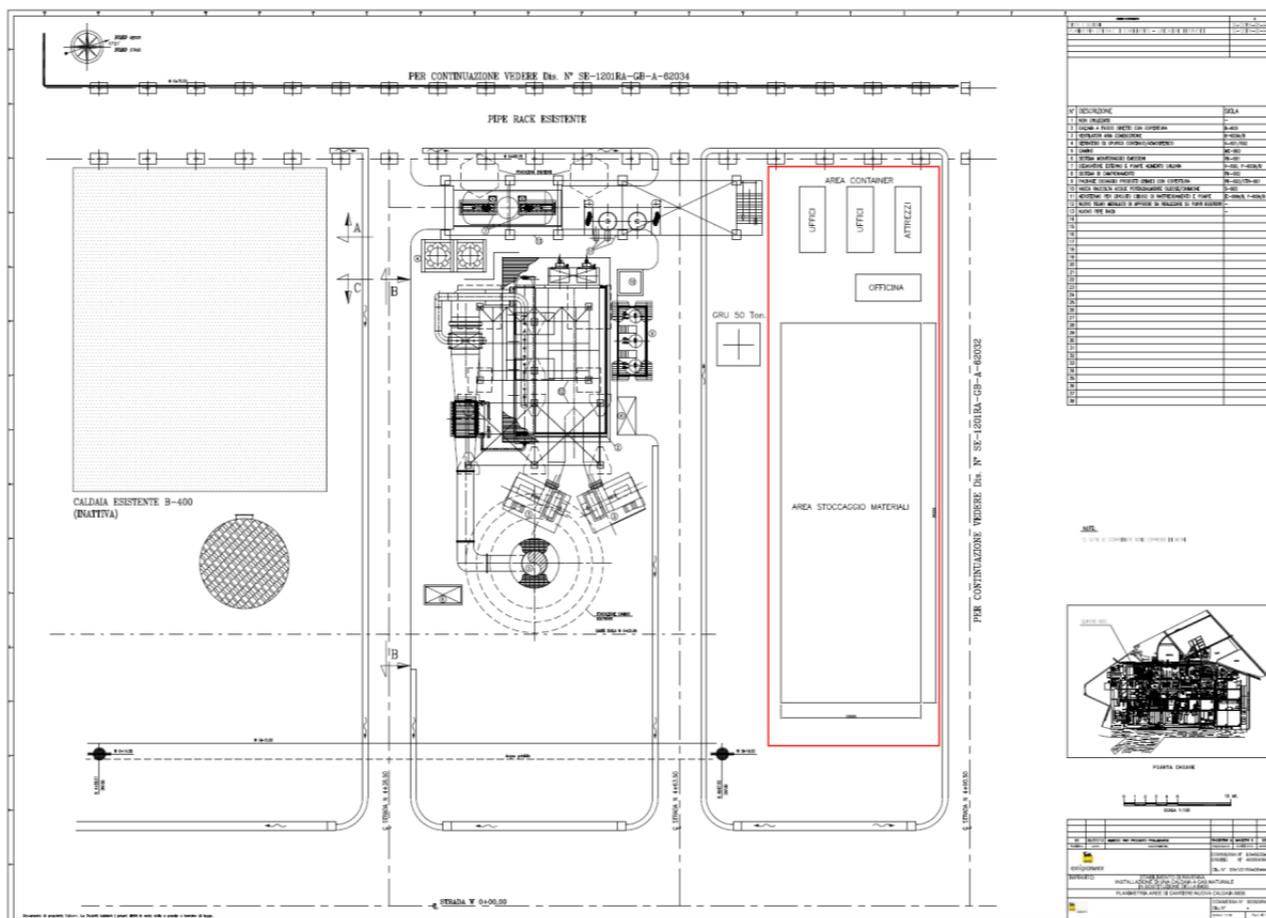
A – Planimetria generale area di cantiere - isola 11
